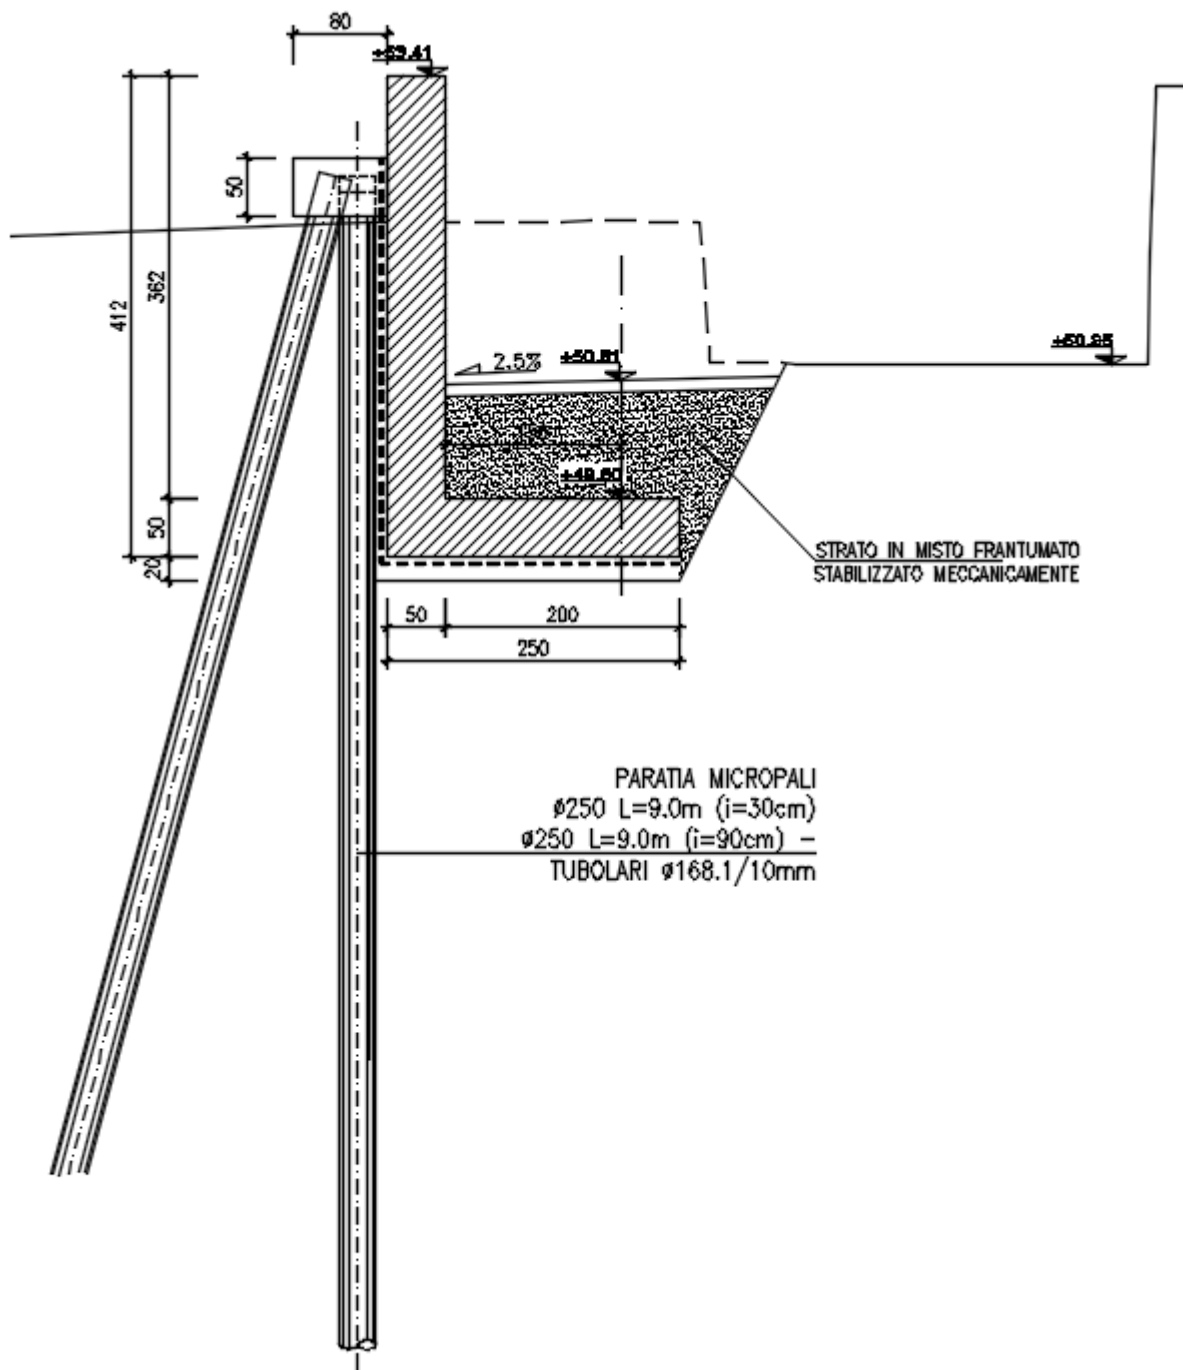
Sezione di calcolo tipo 1 del muro ad L IN04
